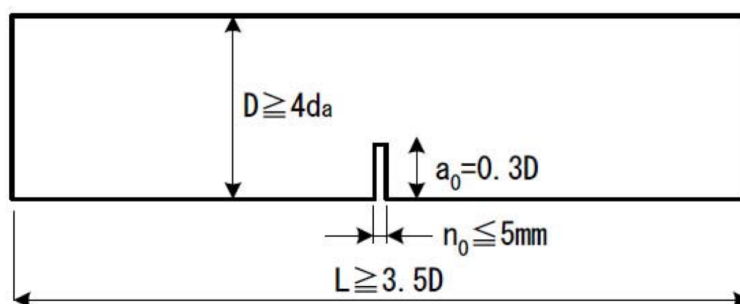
Dimensões do espécimen (JAPAN CONCRETE INSTITUTE, 2003)
